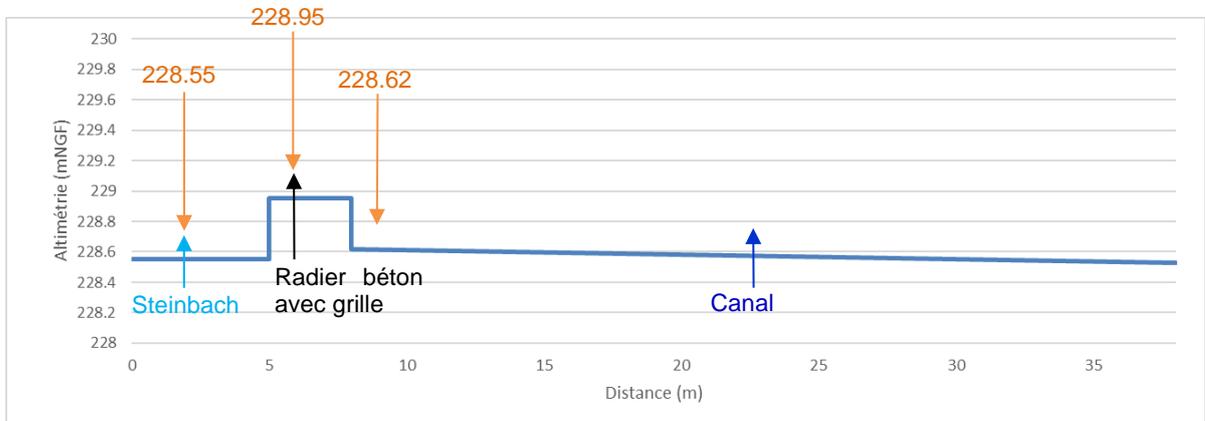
Profil en long du canal, de la prise d'eau à l'entrée de la section souterraine
